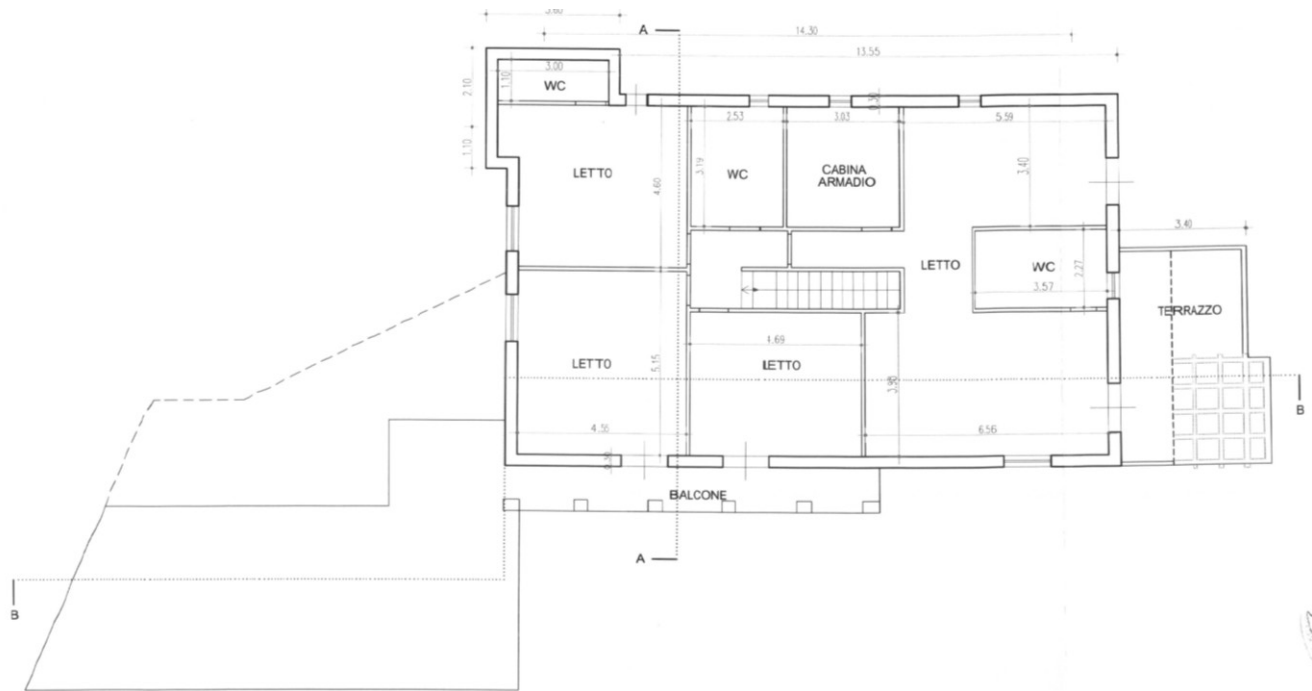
planimetria urbanistica del primo piano della villa secondo il P.d.C. n.70/2022
